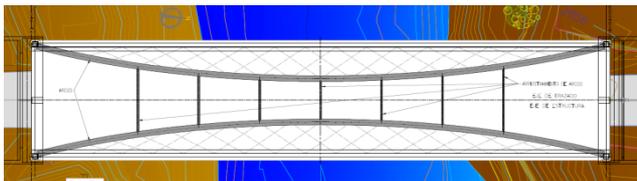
Planta puente Urubamba L=75 m con arriostramiento transversales entre arcos
